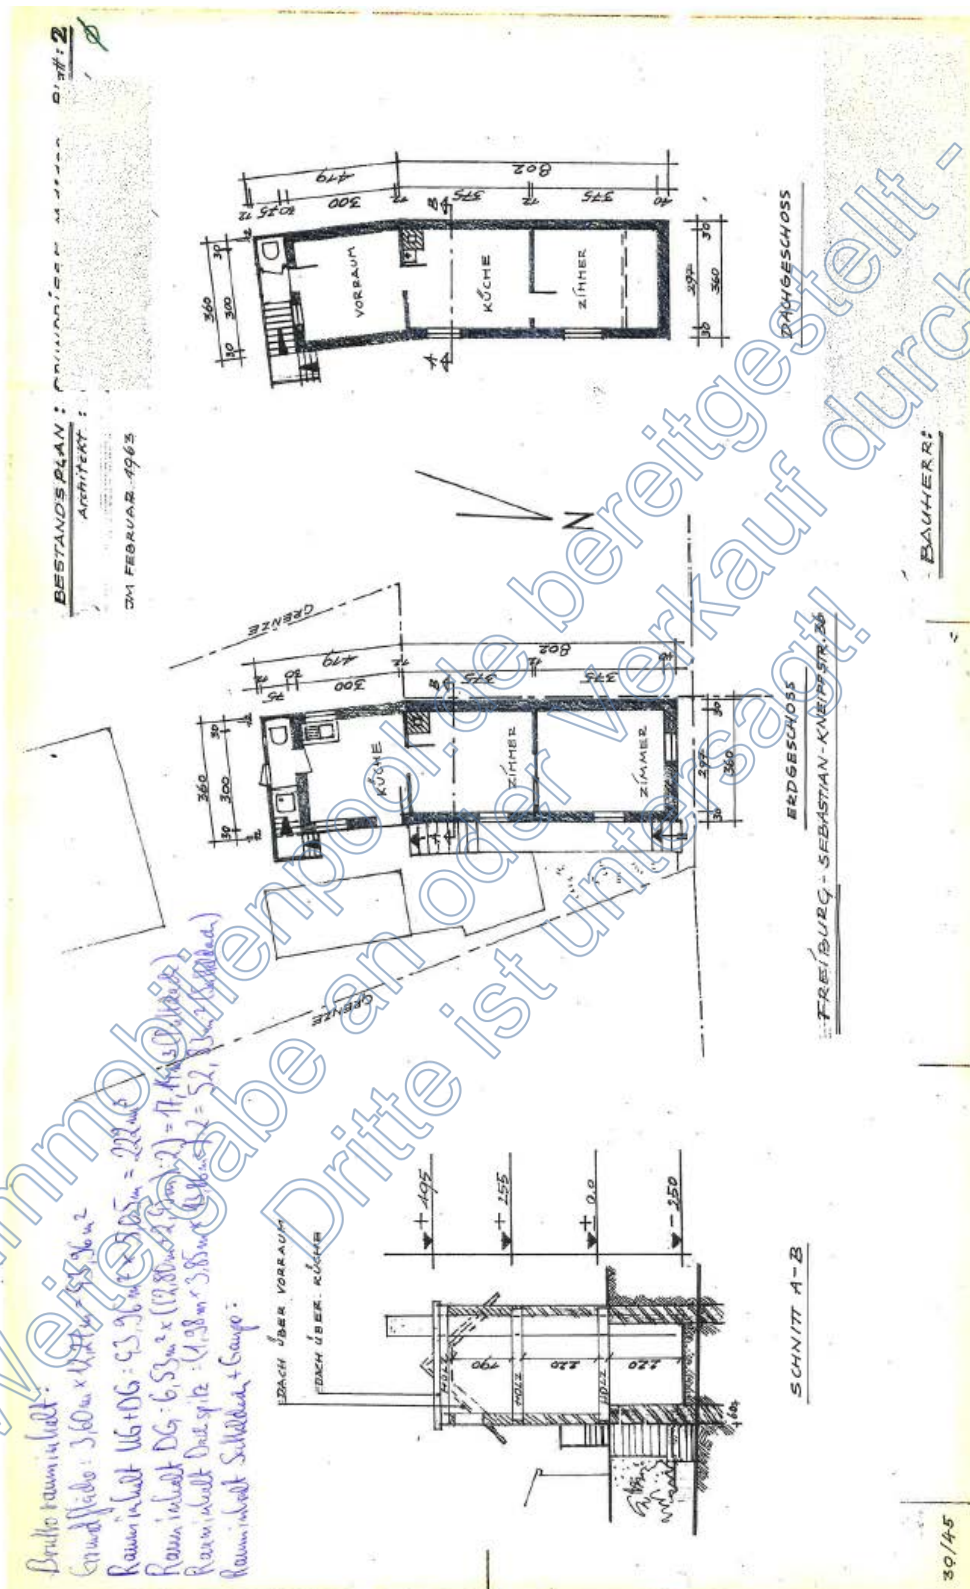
Grundrisse und Schnitt mit Angaben des Eigentümers
